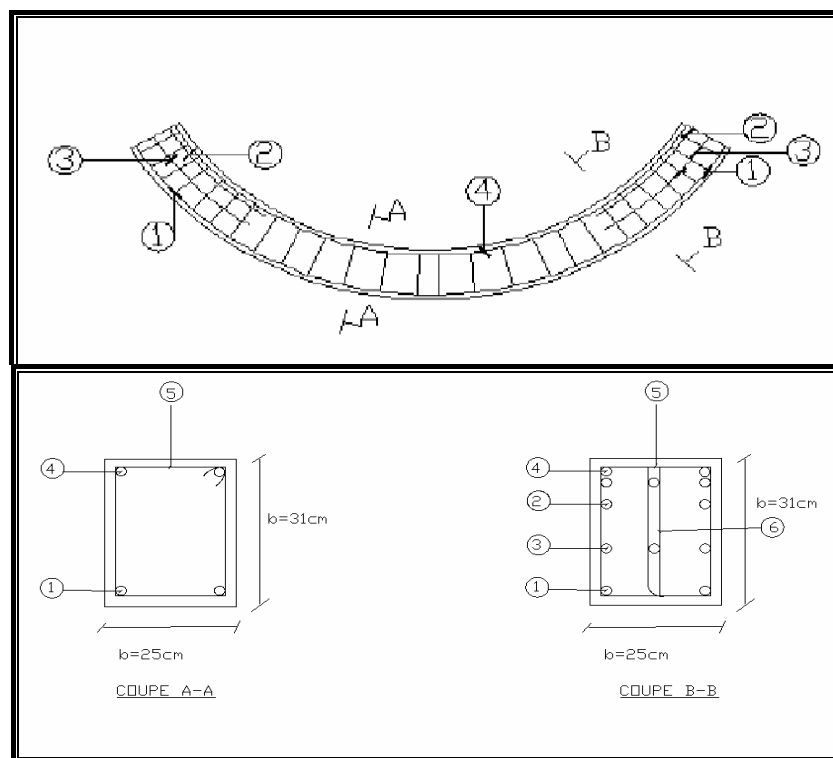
Schéma de ferrailage de la poutre courbe.
